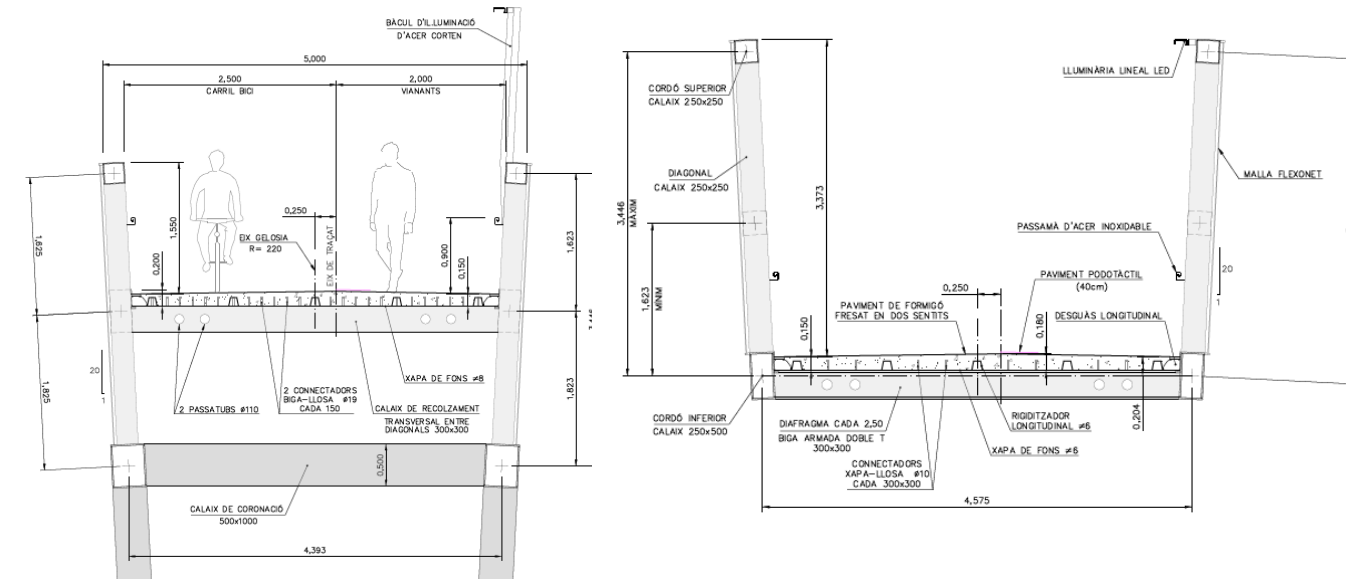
Seccions transversals per pila (esquerra) i centre de tram (dreta)
